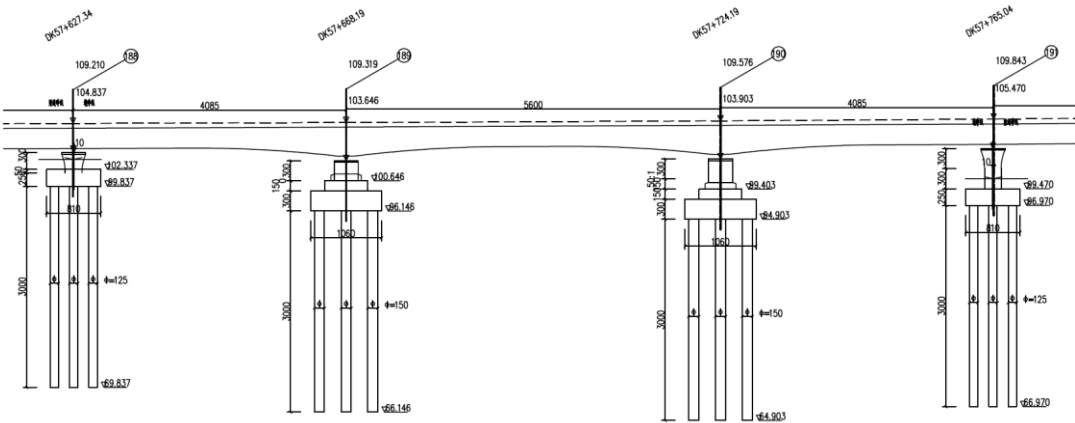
D-6 跨越阿金沟长城的浑河特大桥立面图
